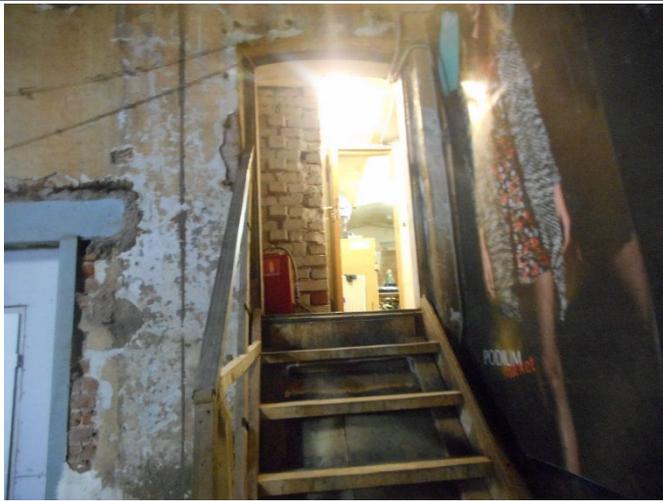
Внутренние помещения пятиэтажного здания общей площадью 2 571,6 кв. м (подвал)
